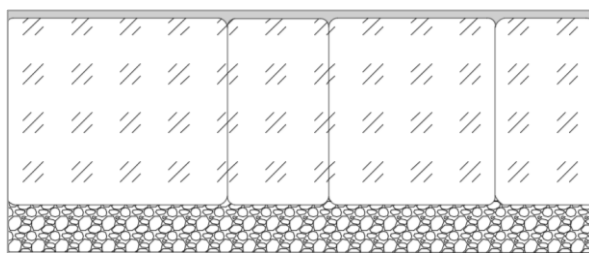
Esquema Pavimento térreo da casa clássica do Porto burguês.
